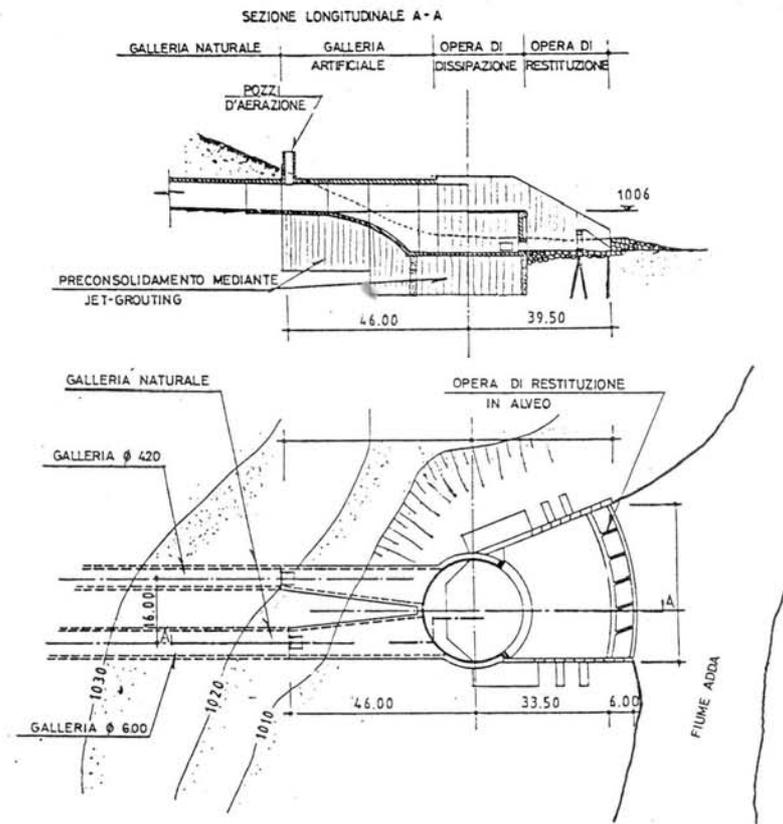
Planimetria e sezione dell'imbocco di valle
